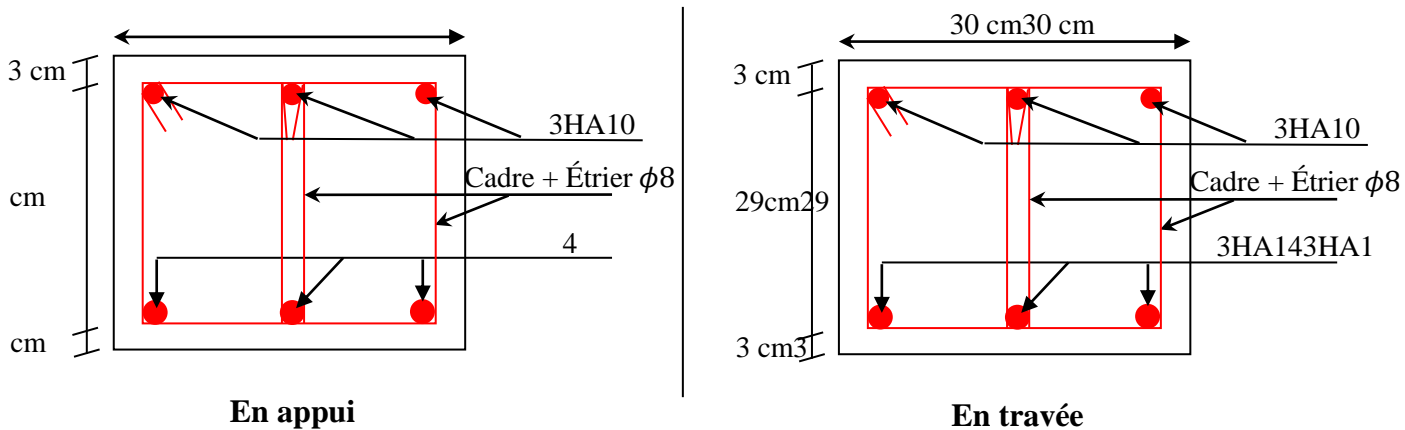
Schéma de ferrailage de la poutre de chaînage
